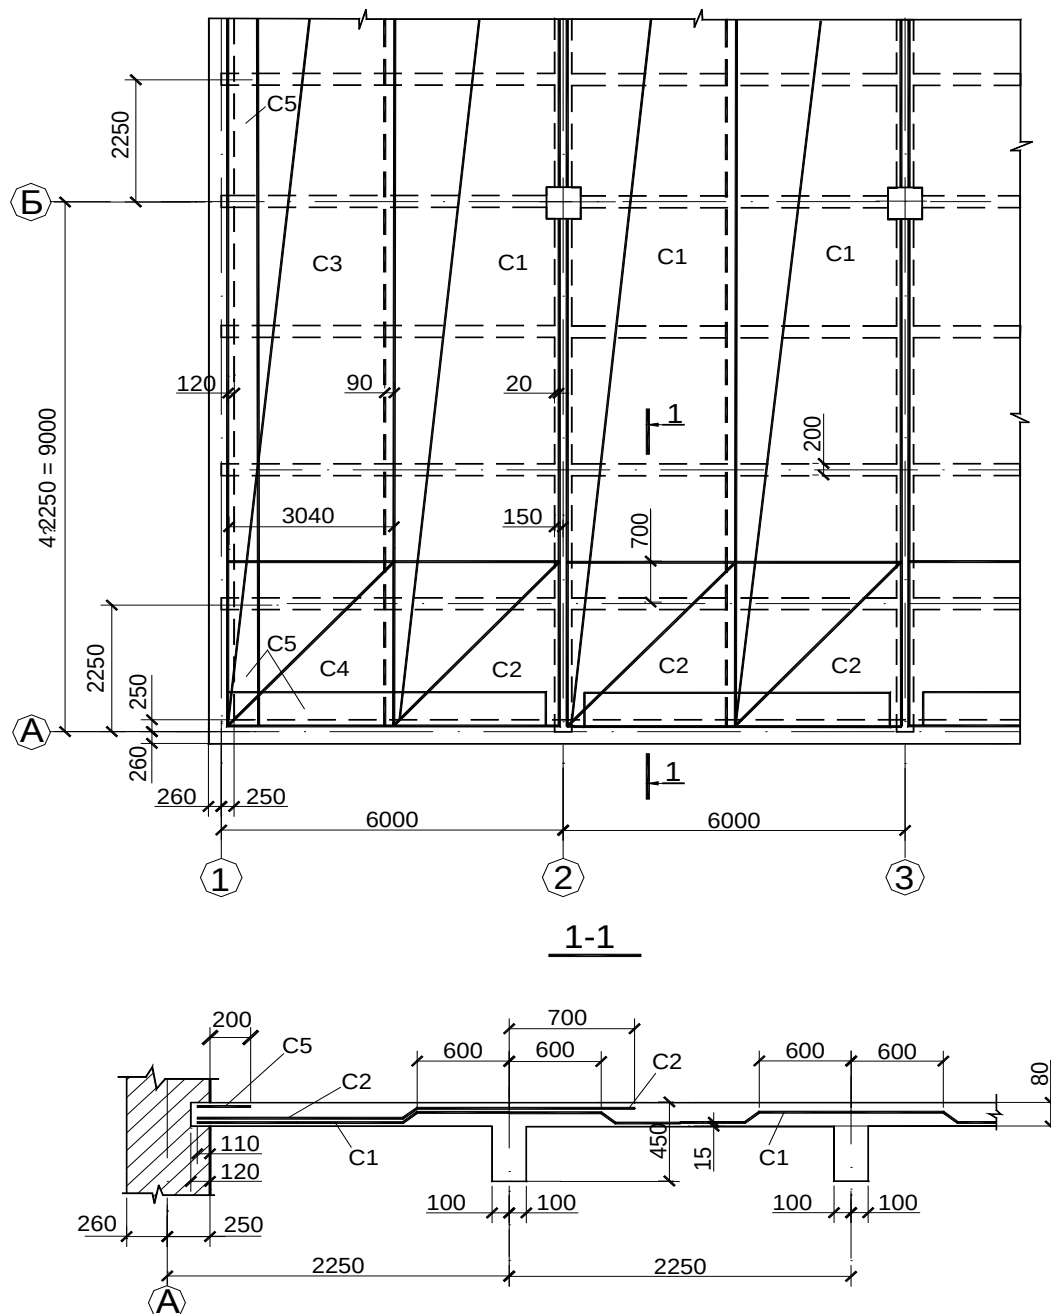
Армирование плиты сварными рулонными сетками с продольным расположением рабочих стержней (вариант I-й)
